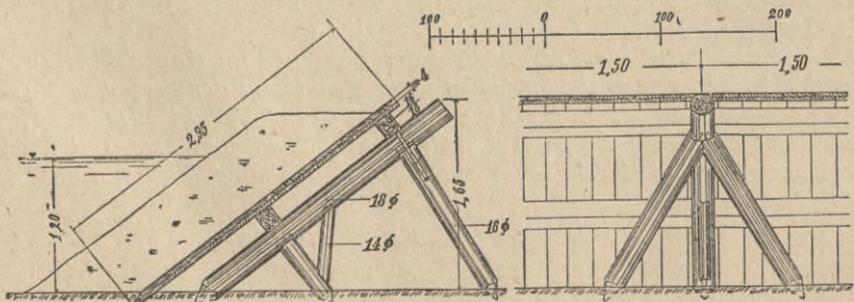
Einfacher Fangedamm auf Schrägböcken.
